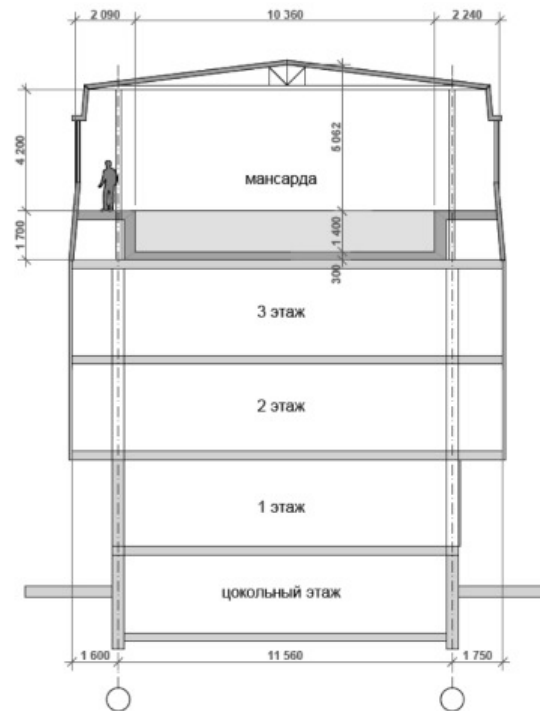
Поперечний розріз будівлі після реконструкції / Cross section of the building after reconstruction
